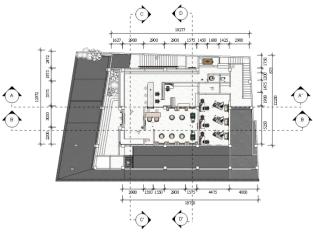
Layout* Baru Lantai Dua (Sumber: Tessalonika, 2024)
